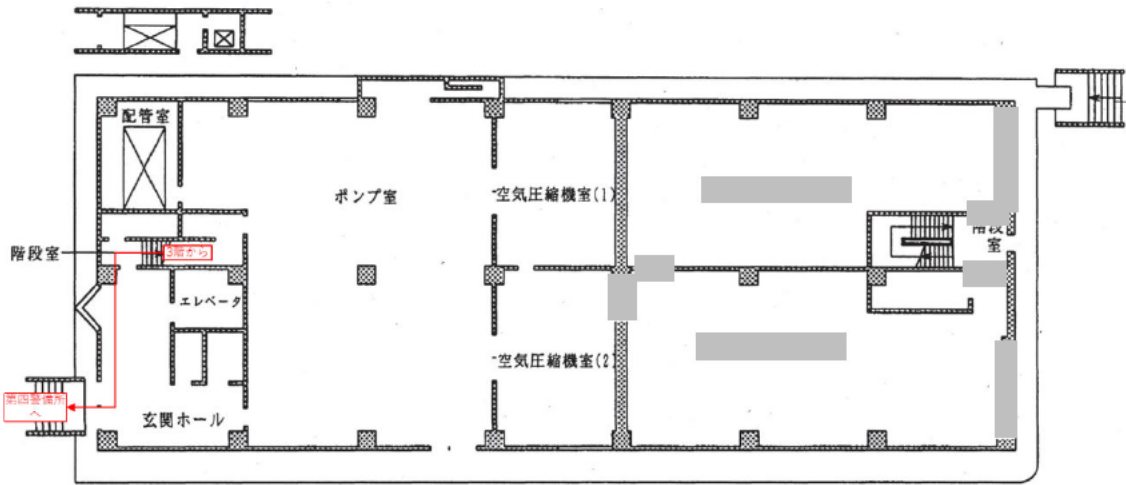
(2) 移動経路 (ユーティリティ施設 地上1F 平面図)
